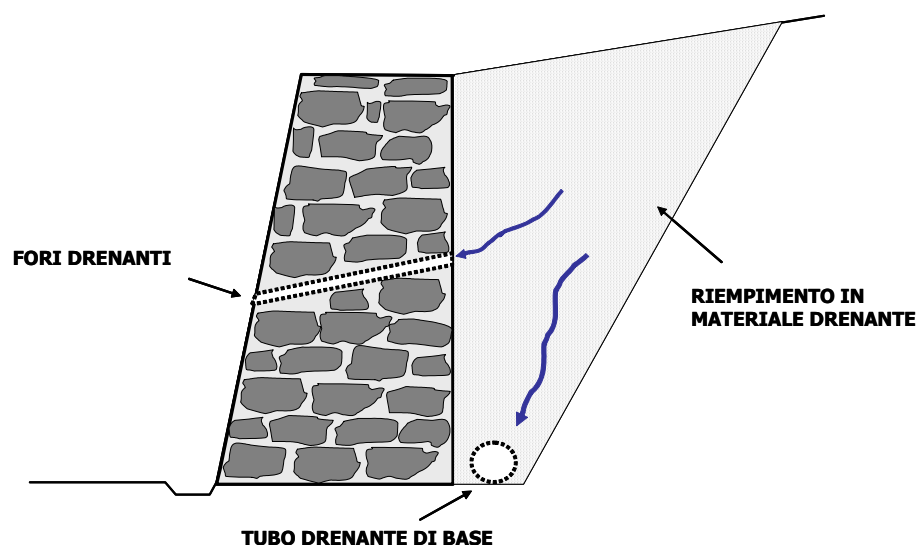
Rappresentazione schematica del sistema di drenaggio alle spalle di un muro in muratura. L'acqua alle spalle della struttura percola attraverso il materiale drenante di riempimento e viene allontanata tramite i fori e le feritoie sulla parete del muro e tramite il tubo drenante alla base della struttura -
